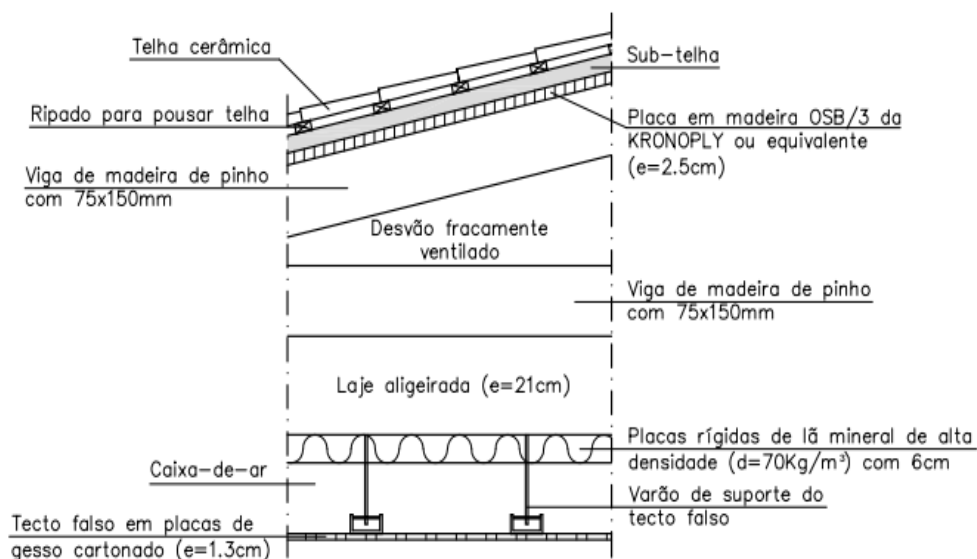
Pormenor construtivo da laje de cobertura [47]
